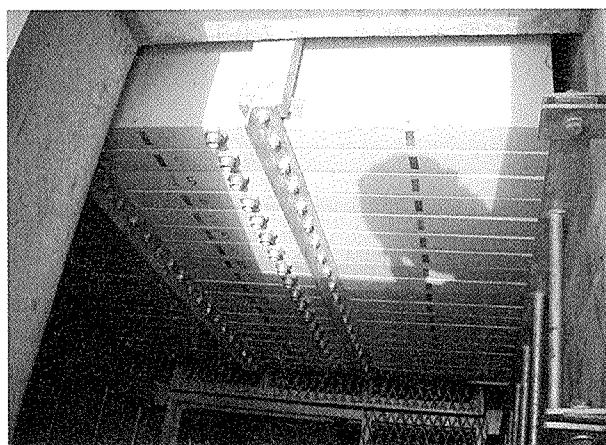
液体ダンパー（主塔最上段、18 段重ね）
